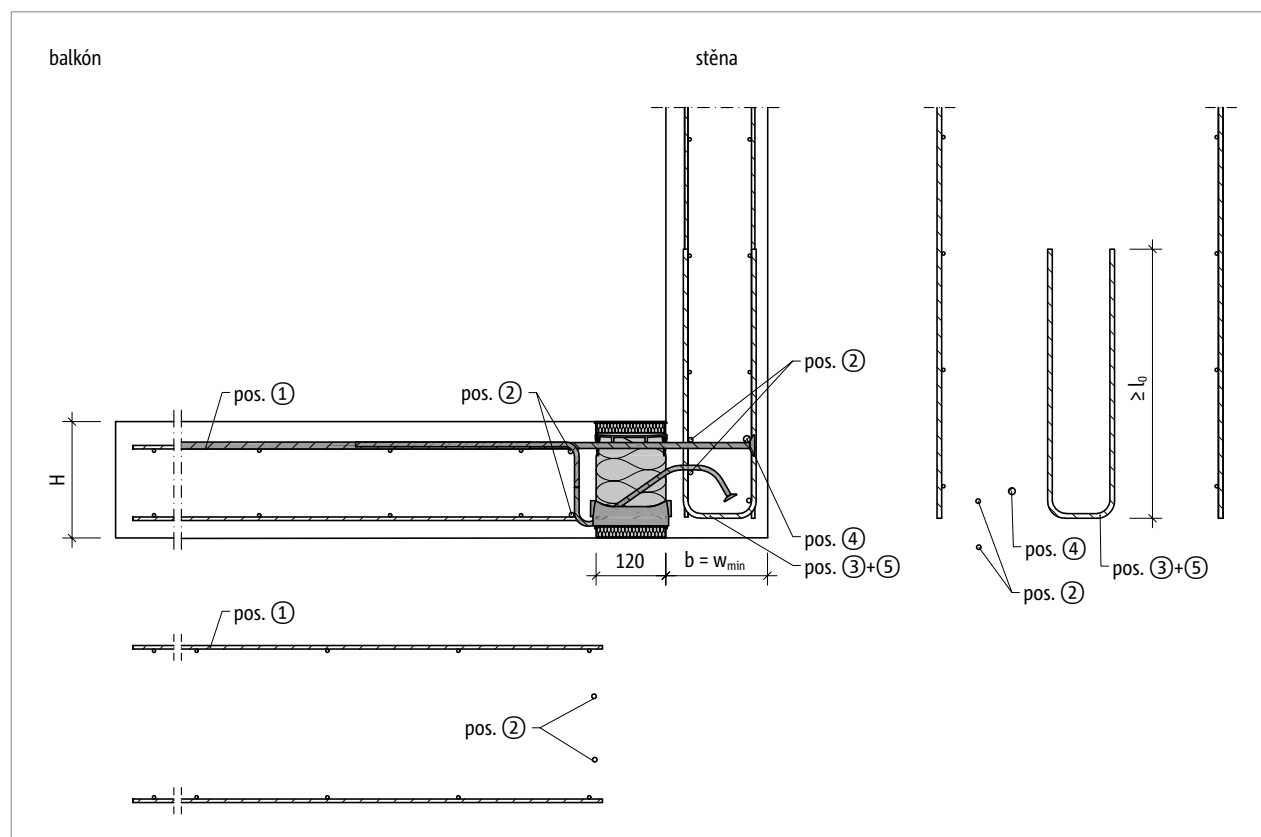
Schöck Isokorb® XT typ KL-U: Napojovací stavební výztuž pro balkón snížený oproti stropní desce – s minimálním rozměrem ($w_{skut} = w_{min}$)
